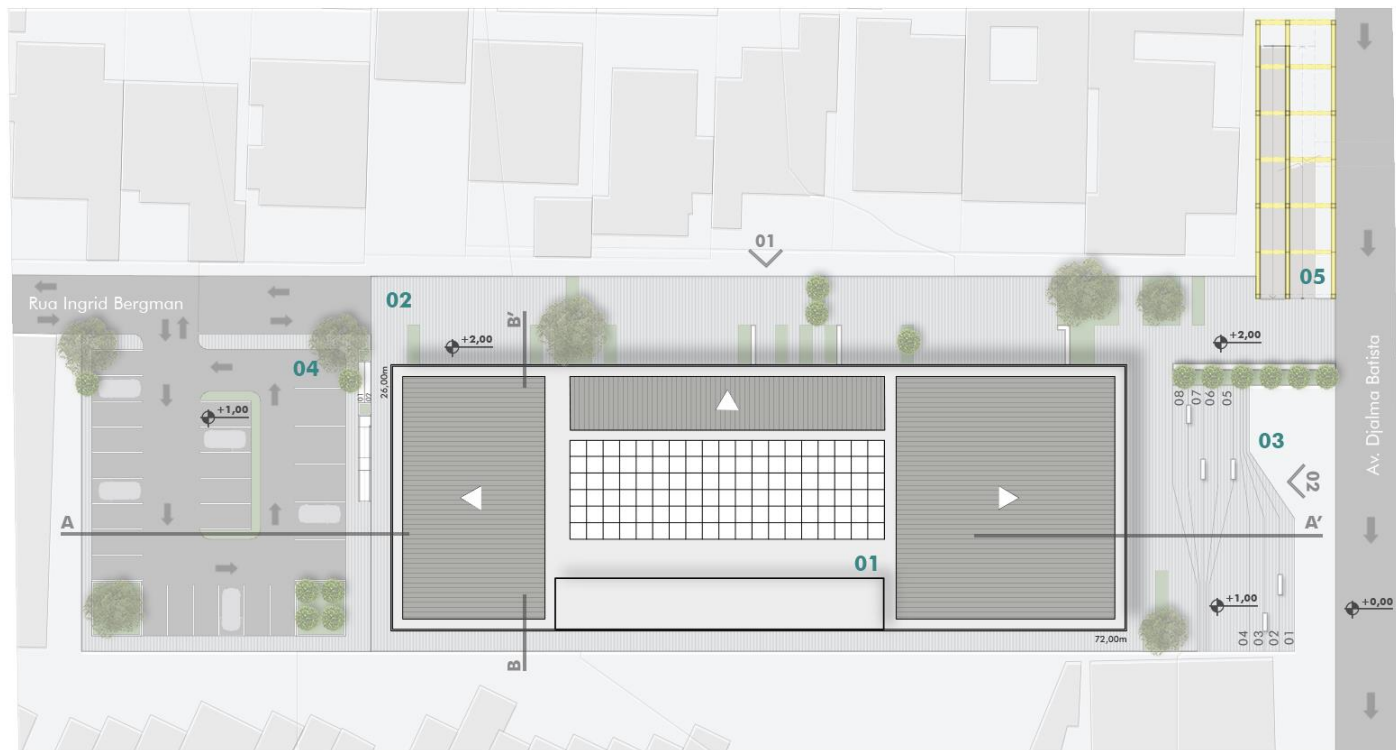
Plano de manchas em corte esquemático. Fonte: acervo da autora, 2021
